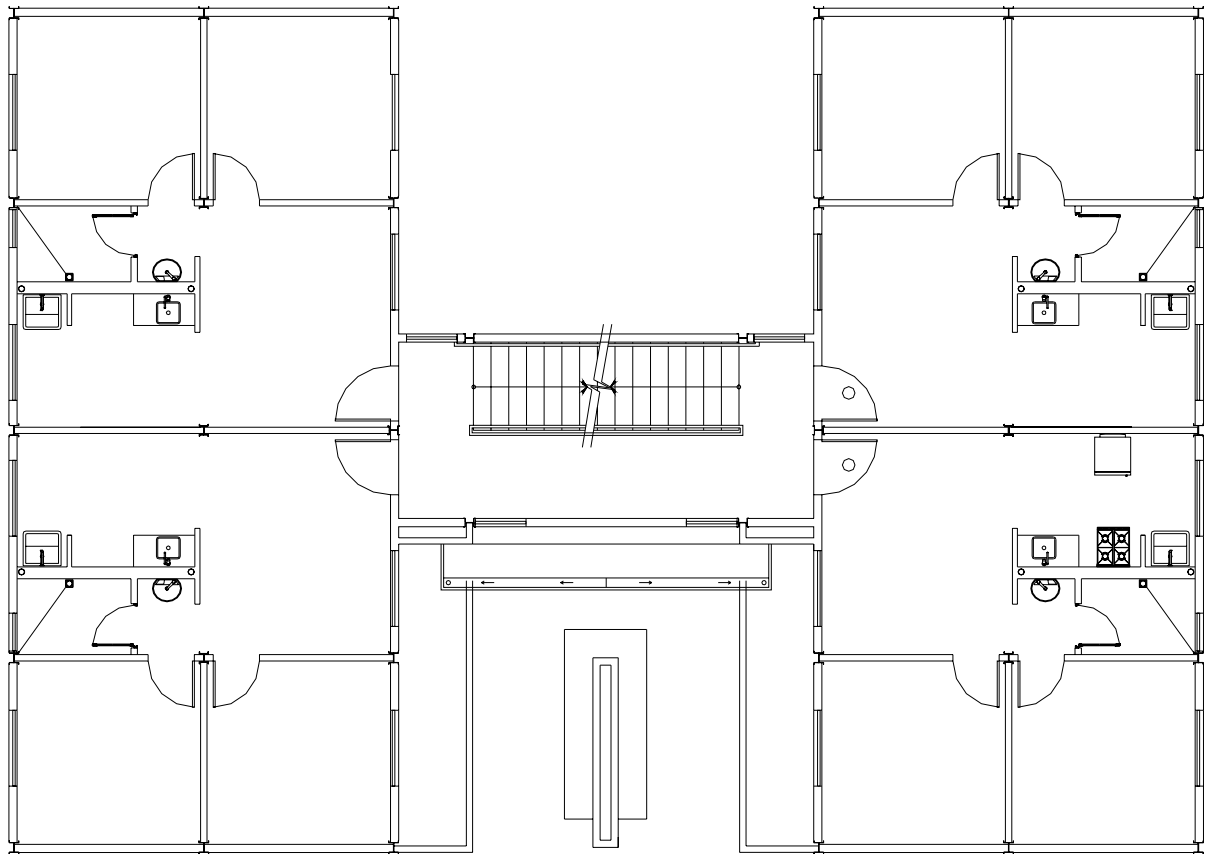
Arquitetura do Pavimento Tipo – Arquitetura tipo “B”
